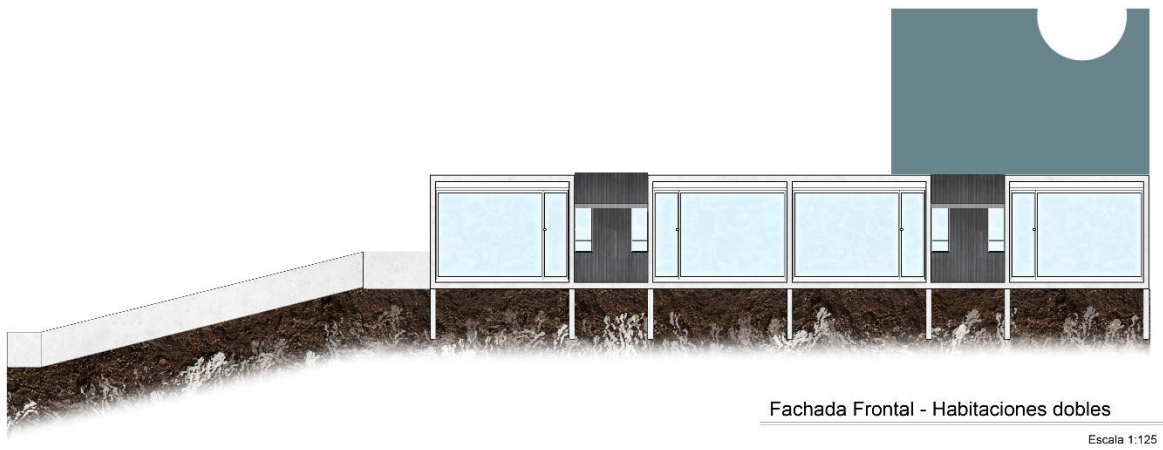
Fachadas arquitectónicas – habitaciones dobles
